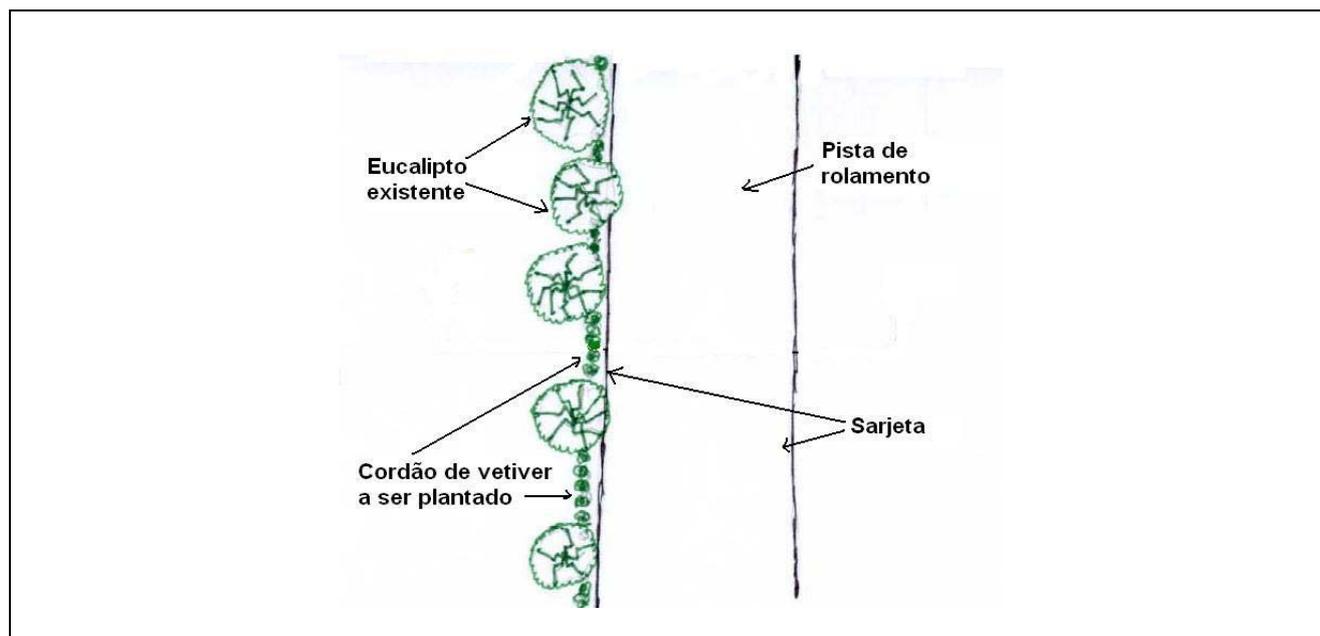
Desenho esquemático EPV 06 – Planta baixa.
